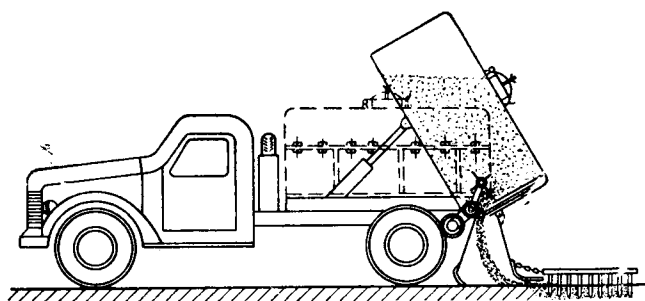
Автомобиль-самосвал, переоборудованный под цементовоз-дозатор
